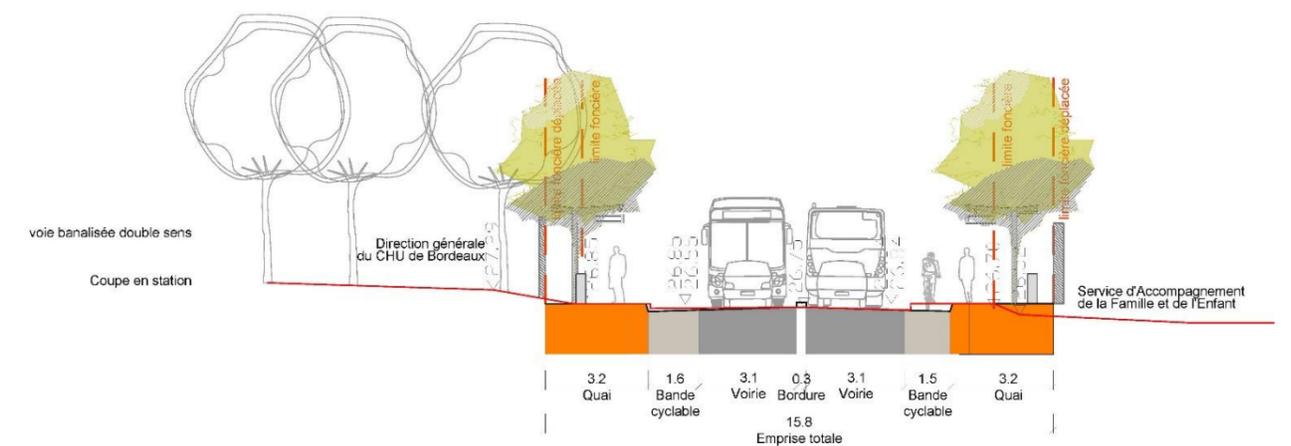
Coupe type sur l'avenue de la Vieille Tour
